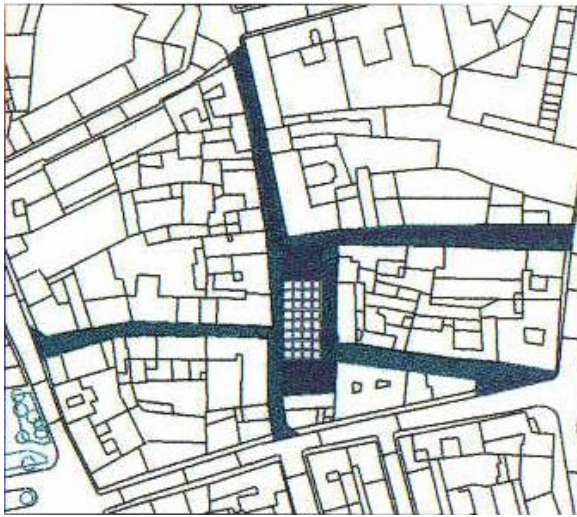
e 3: due planimetrie di plaza Mayor a Villaverde Bajo, gli spazi aperti oggetto delle opere e la trama della nuova pavimentazione della piazza (1).
